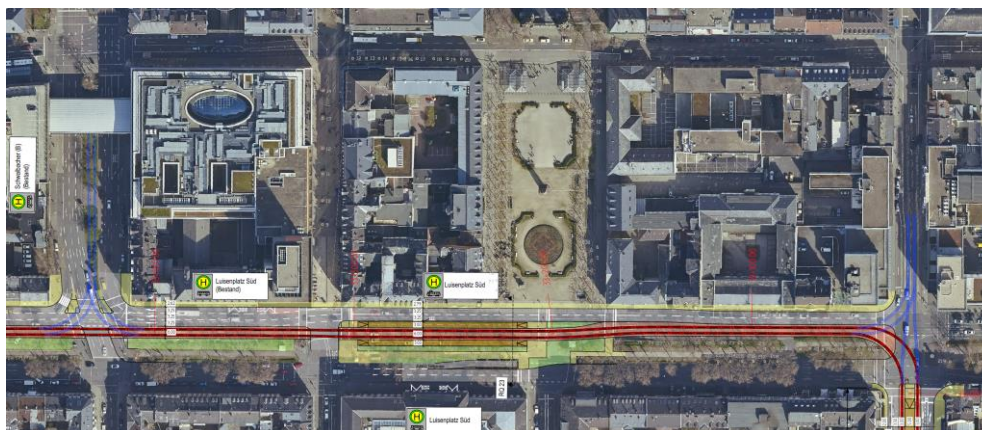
Lageplanausschnitt Vorplanung CityBahn mit Anschluss Innenstadt
